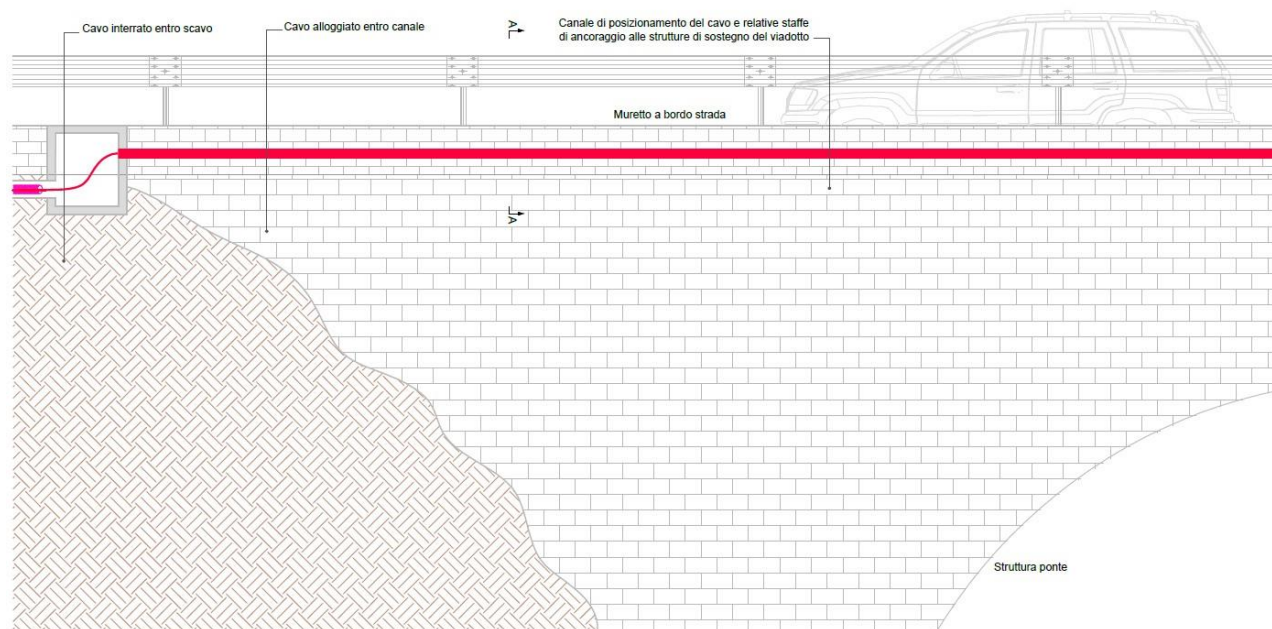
Risoluzione interferenza attraversamento ponte mediante staffaggio
